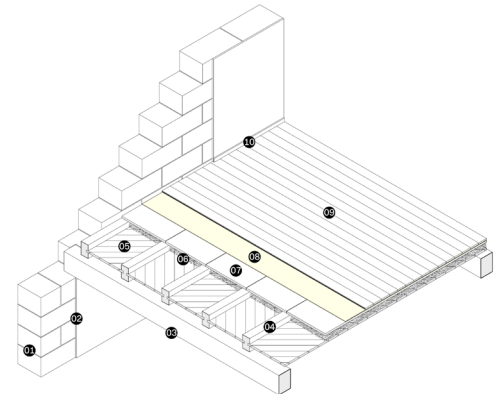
Deckenkonstruktion mit Unterzügen und Balkenlage
